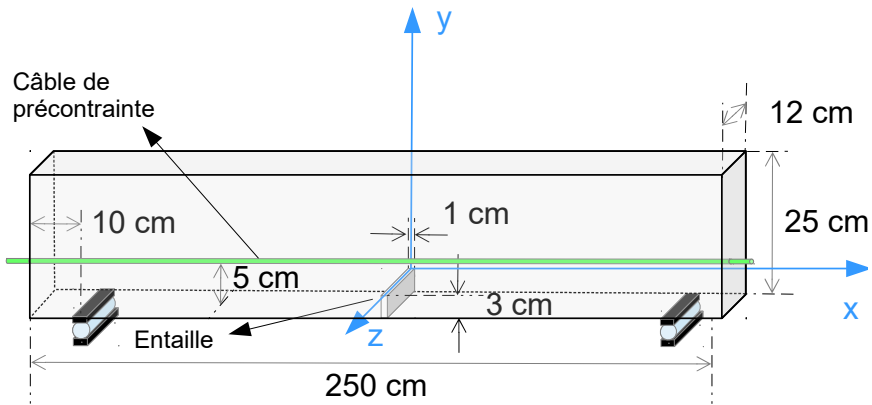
Schéma et dimension des poutres p2-x pour la refermeture de fissure.
